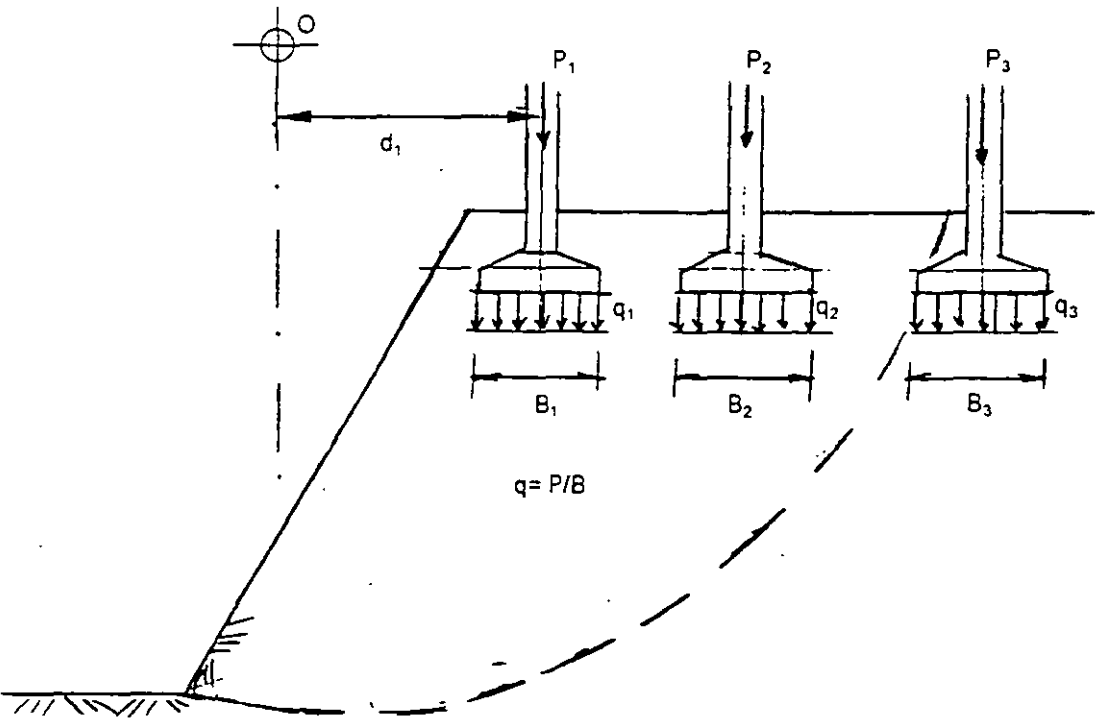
Sobrecarga por zapatas aisladas o continuas
